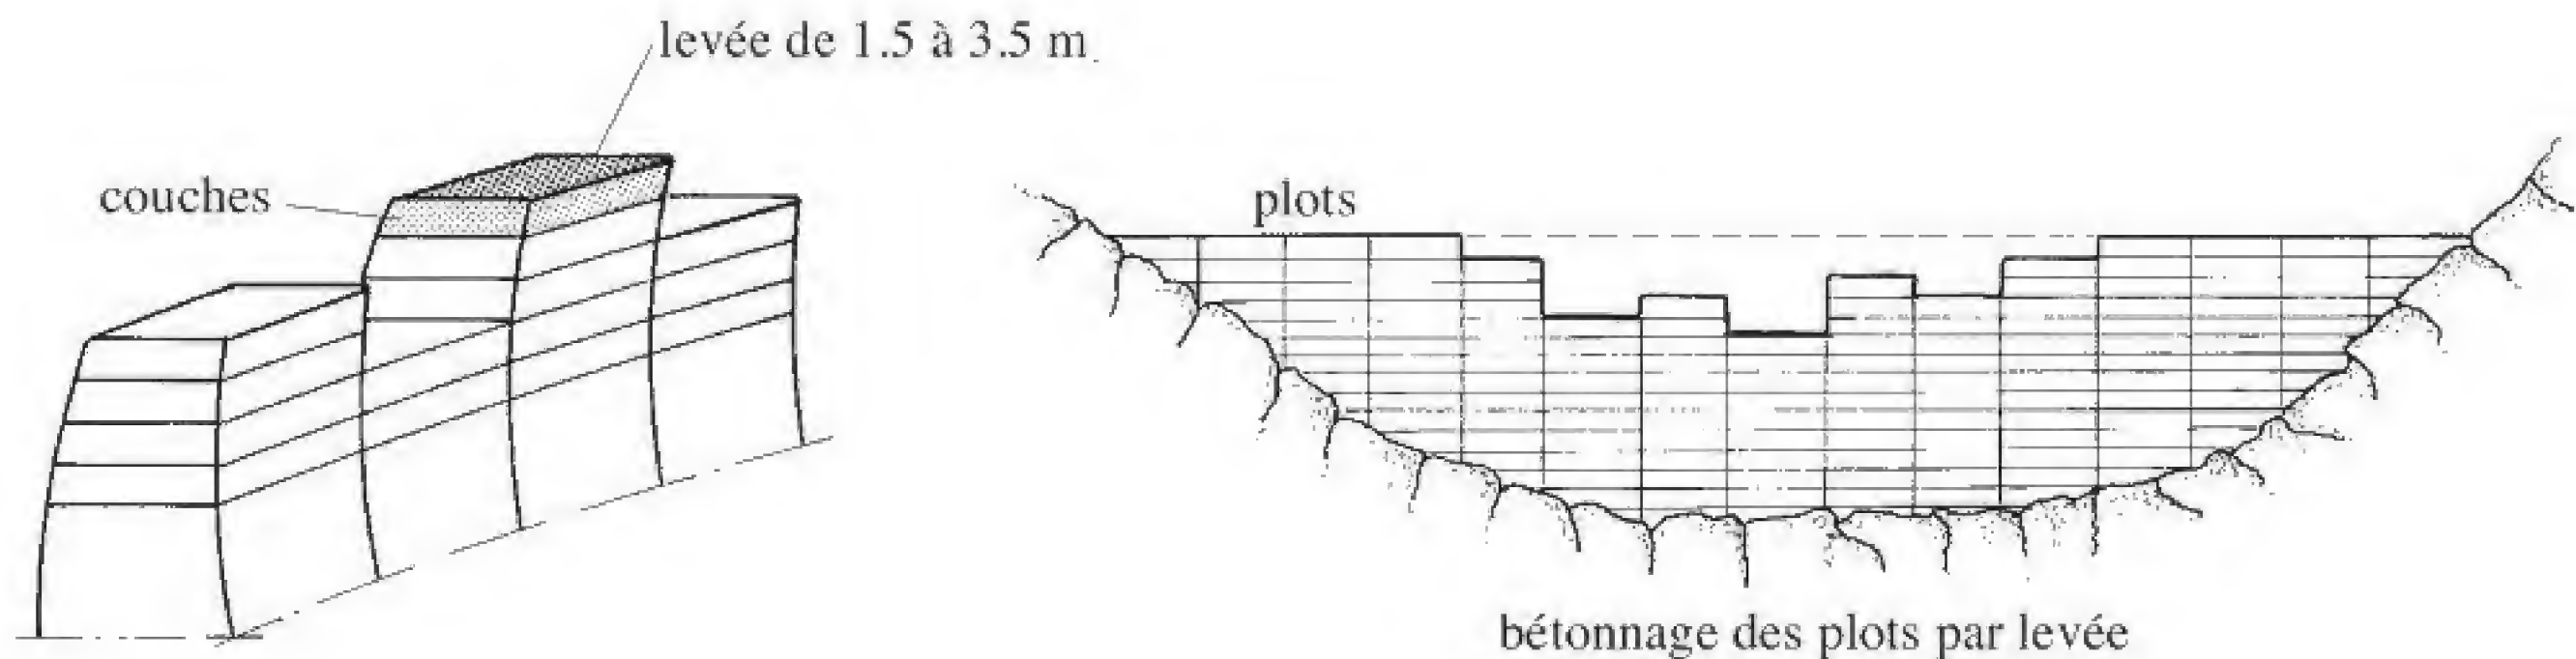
Barrages en béton – étapes de bétonnage en escaliers.
